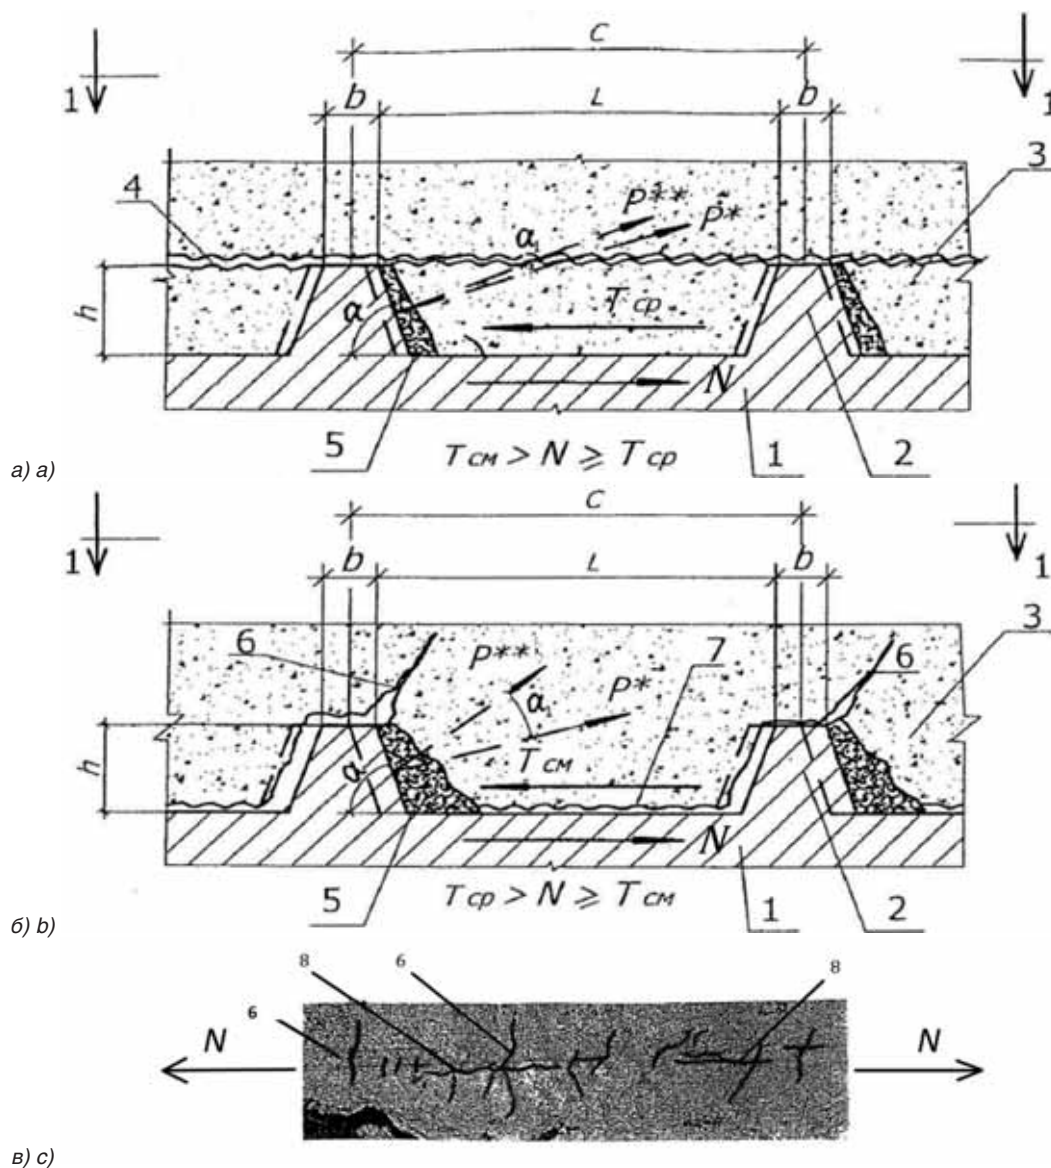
Характер разрушения бетонных шпонок при сдвиге: а) От среза; б) От смятия; в) Трещины в бетоне на нижней поверхности ж/б балки; 1 – сердечник арматуры; 2 – поперечное ребро; 3 – бетон; 4 – поверхность среза; 5 – зоны смятия бетона; 6 – поперечные трещины от смятия; 7 – отслоение бетона от арматуры в результате распора; 8 – продольные трещины от распора; N – внешнее усилие; T_{cp} и T_{cm} – разрушающие усилия от среза и от смятия
